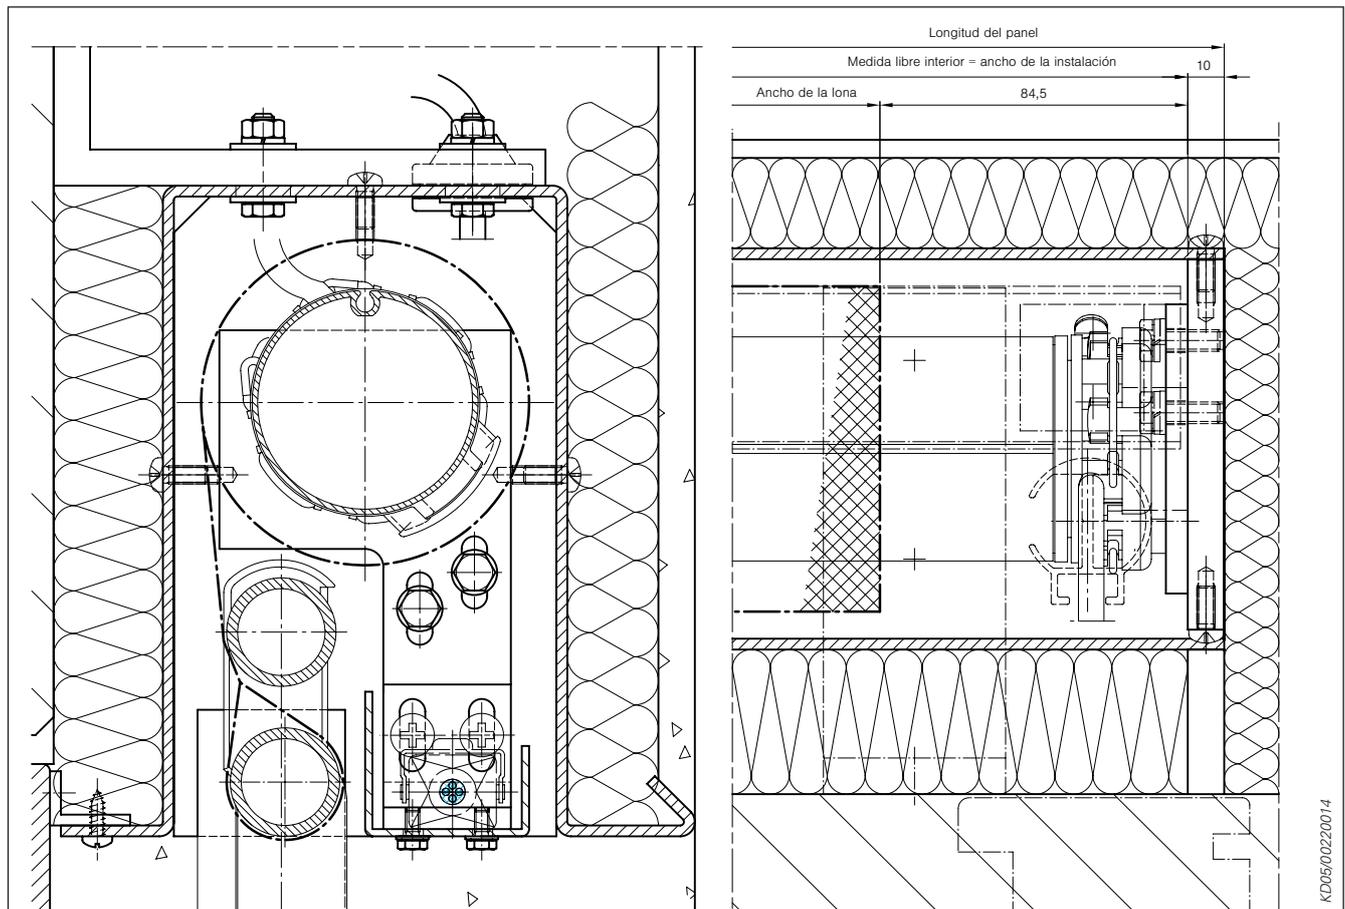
Marquisoleta Modelo 109 E con carril redondo Ø35 en fachada con aislamiento térmico
